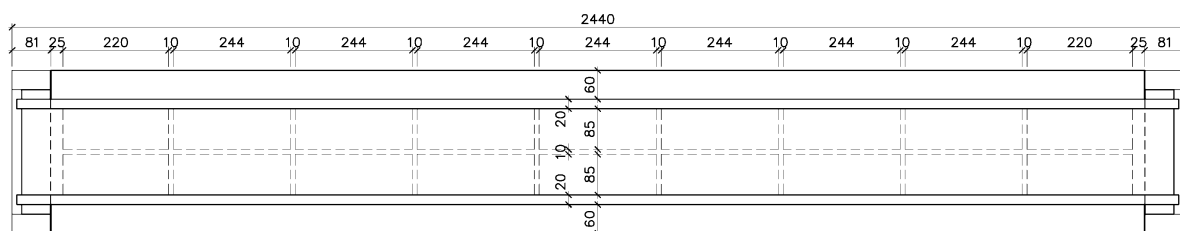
Projeto estrutural: planta. Dimensões em (cm)
